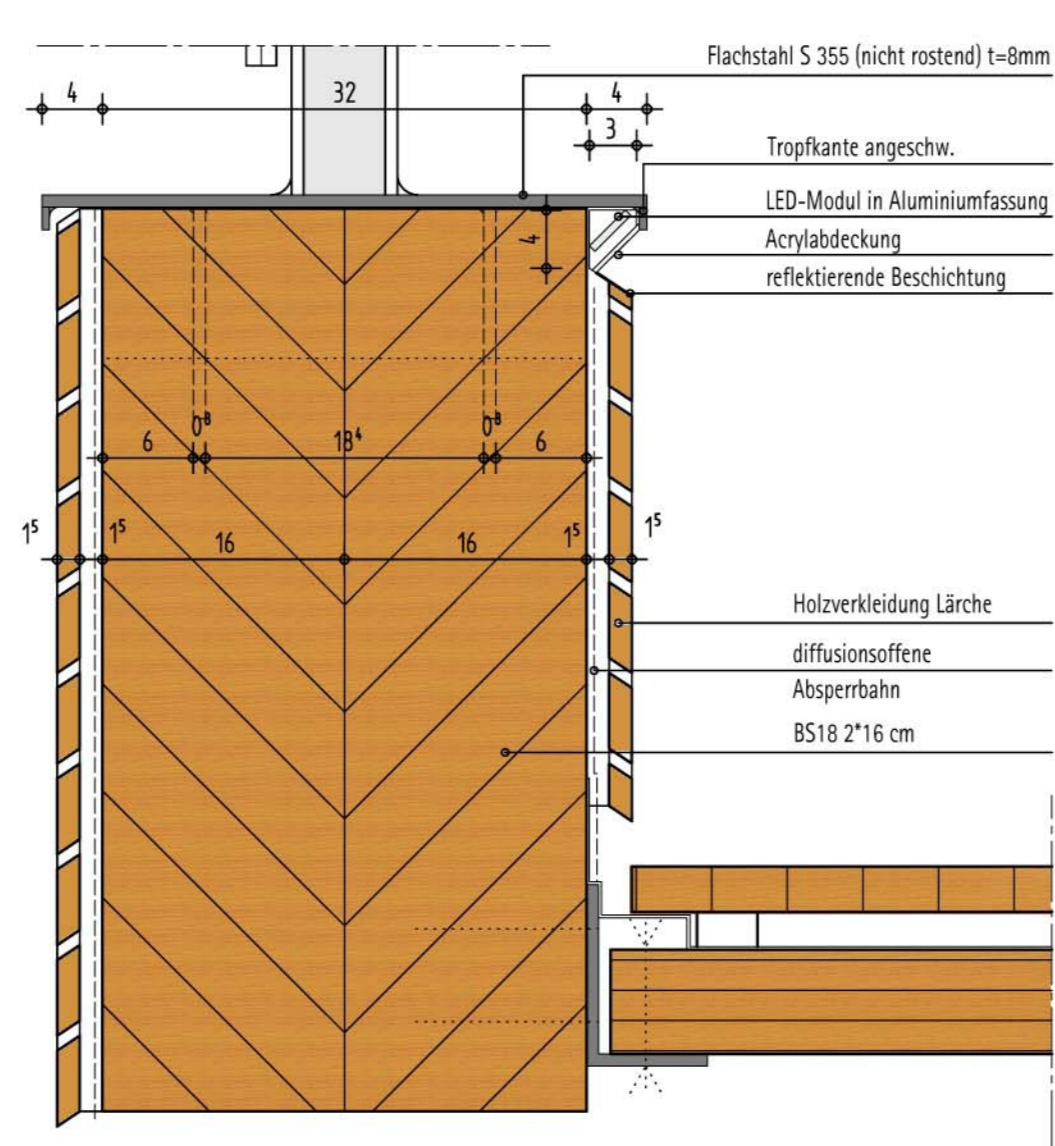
Teilquerschnitt Mittelaullager M. 1:10
